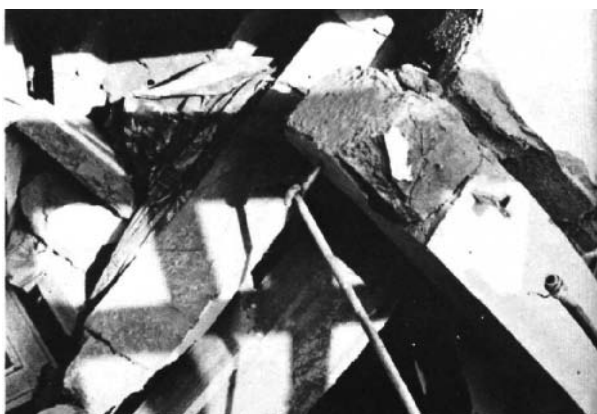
Détail à l'Hôtel Saada, notez les fractures des poutres et des solives
